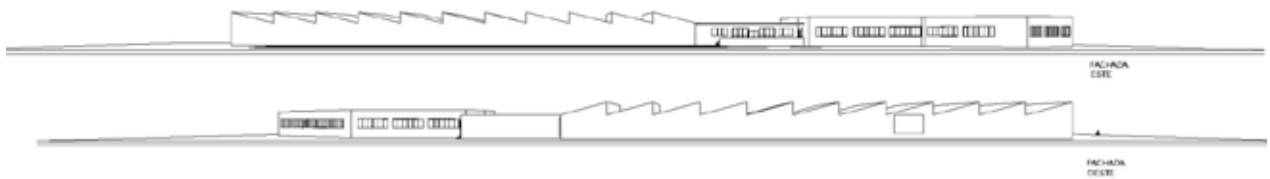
Planta Procesadora de Pescado, Fachadas. (2016)
